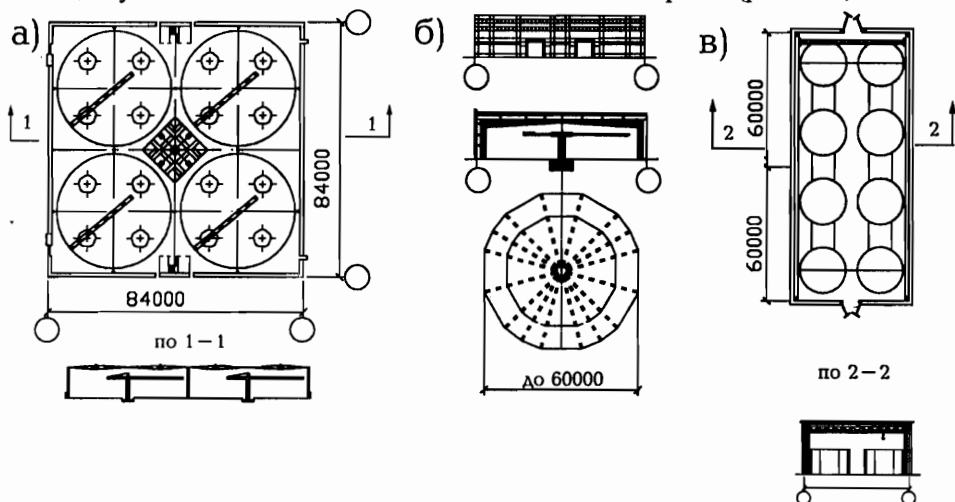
Промышленные здания зального типа с технологическими кранами: а – башенным с вылетом стрелы 20 м; б – то же с вылетом стрелы 30 м; в – козловым на пролет 60 м
